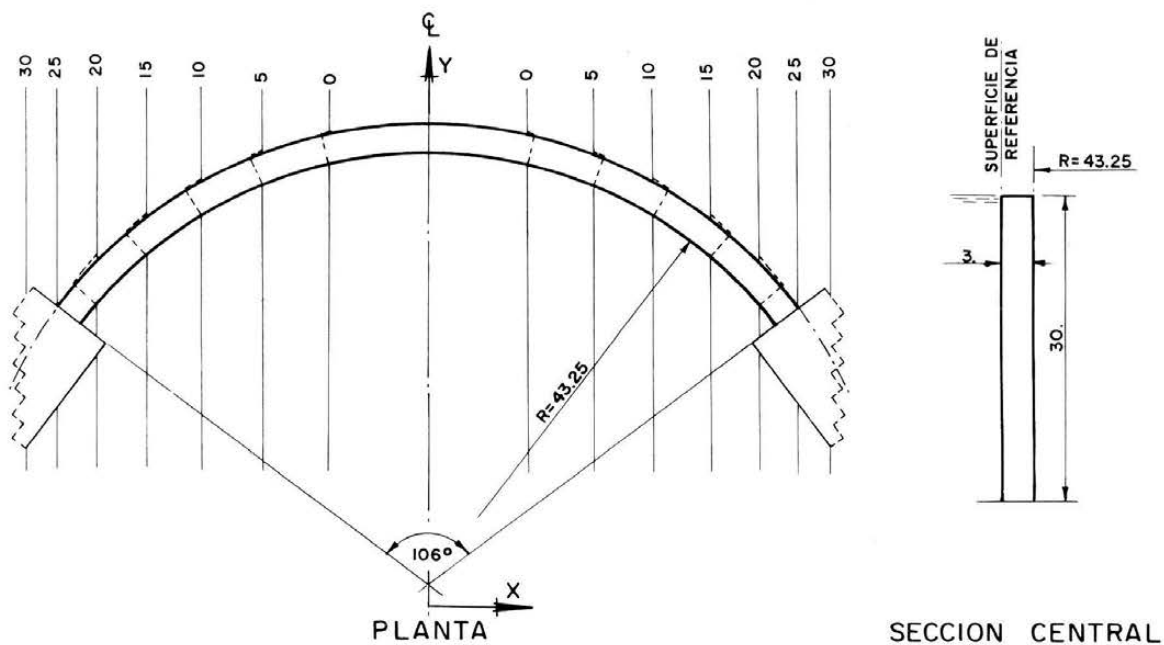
Presa tipo 1: Planta y sección en ménsula central.
